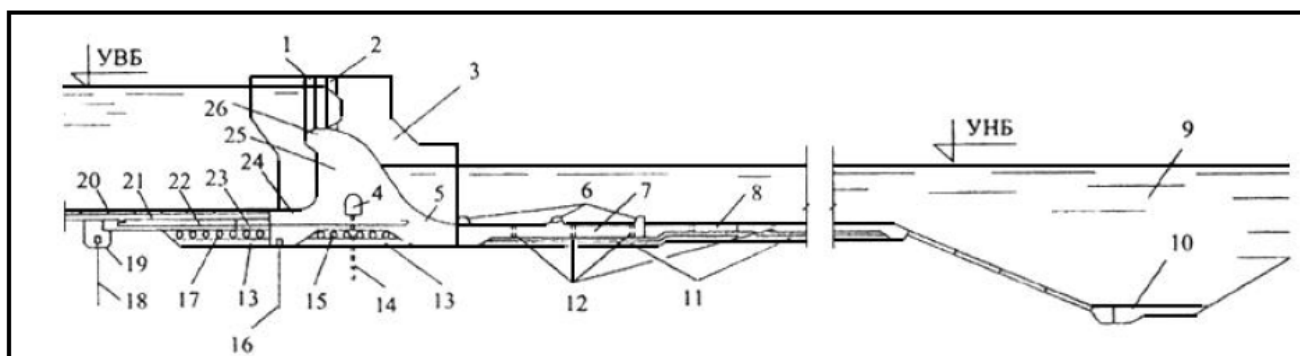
Схема элементов водосливной плотины: 1 - паз ремонтного затвора; 2 - паз рабочего затвора; 3 - промежуточный бык; 4 - дренажная галерея; 5 - низовой участок фундаментной плиты; 6 - гасители энергии; 7- водобой; 8 - рисберма; 9 - ковш; 10 - переходное деформируемое крепление; 11 - горизонтальный дренаж водобоя и рисбермы; 12 - дренажные колодцы; 13 - обратный фильтр; 14 - вертикальный дренаж основания; 15 - горизонтальный дренаж фундаментной плиты; 16 - верховой подплотинный шпунт; 17 - горизонтальный дренаж понура; 18 - понурный шпунт; 19 - надшпунтовая балка; 20 - крепление пригрузки; 21 - пригрузка понура; 22 - анкерный понур; 23 - гибкий участок анкерного понура; 24 - верховой участок фундаментной плиты; 25 - водослив; 26 - гребень водослива [23]
